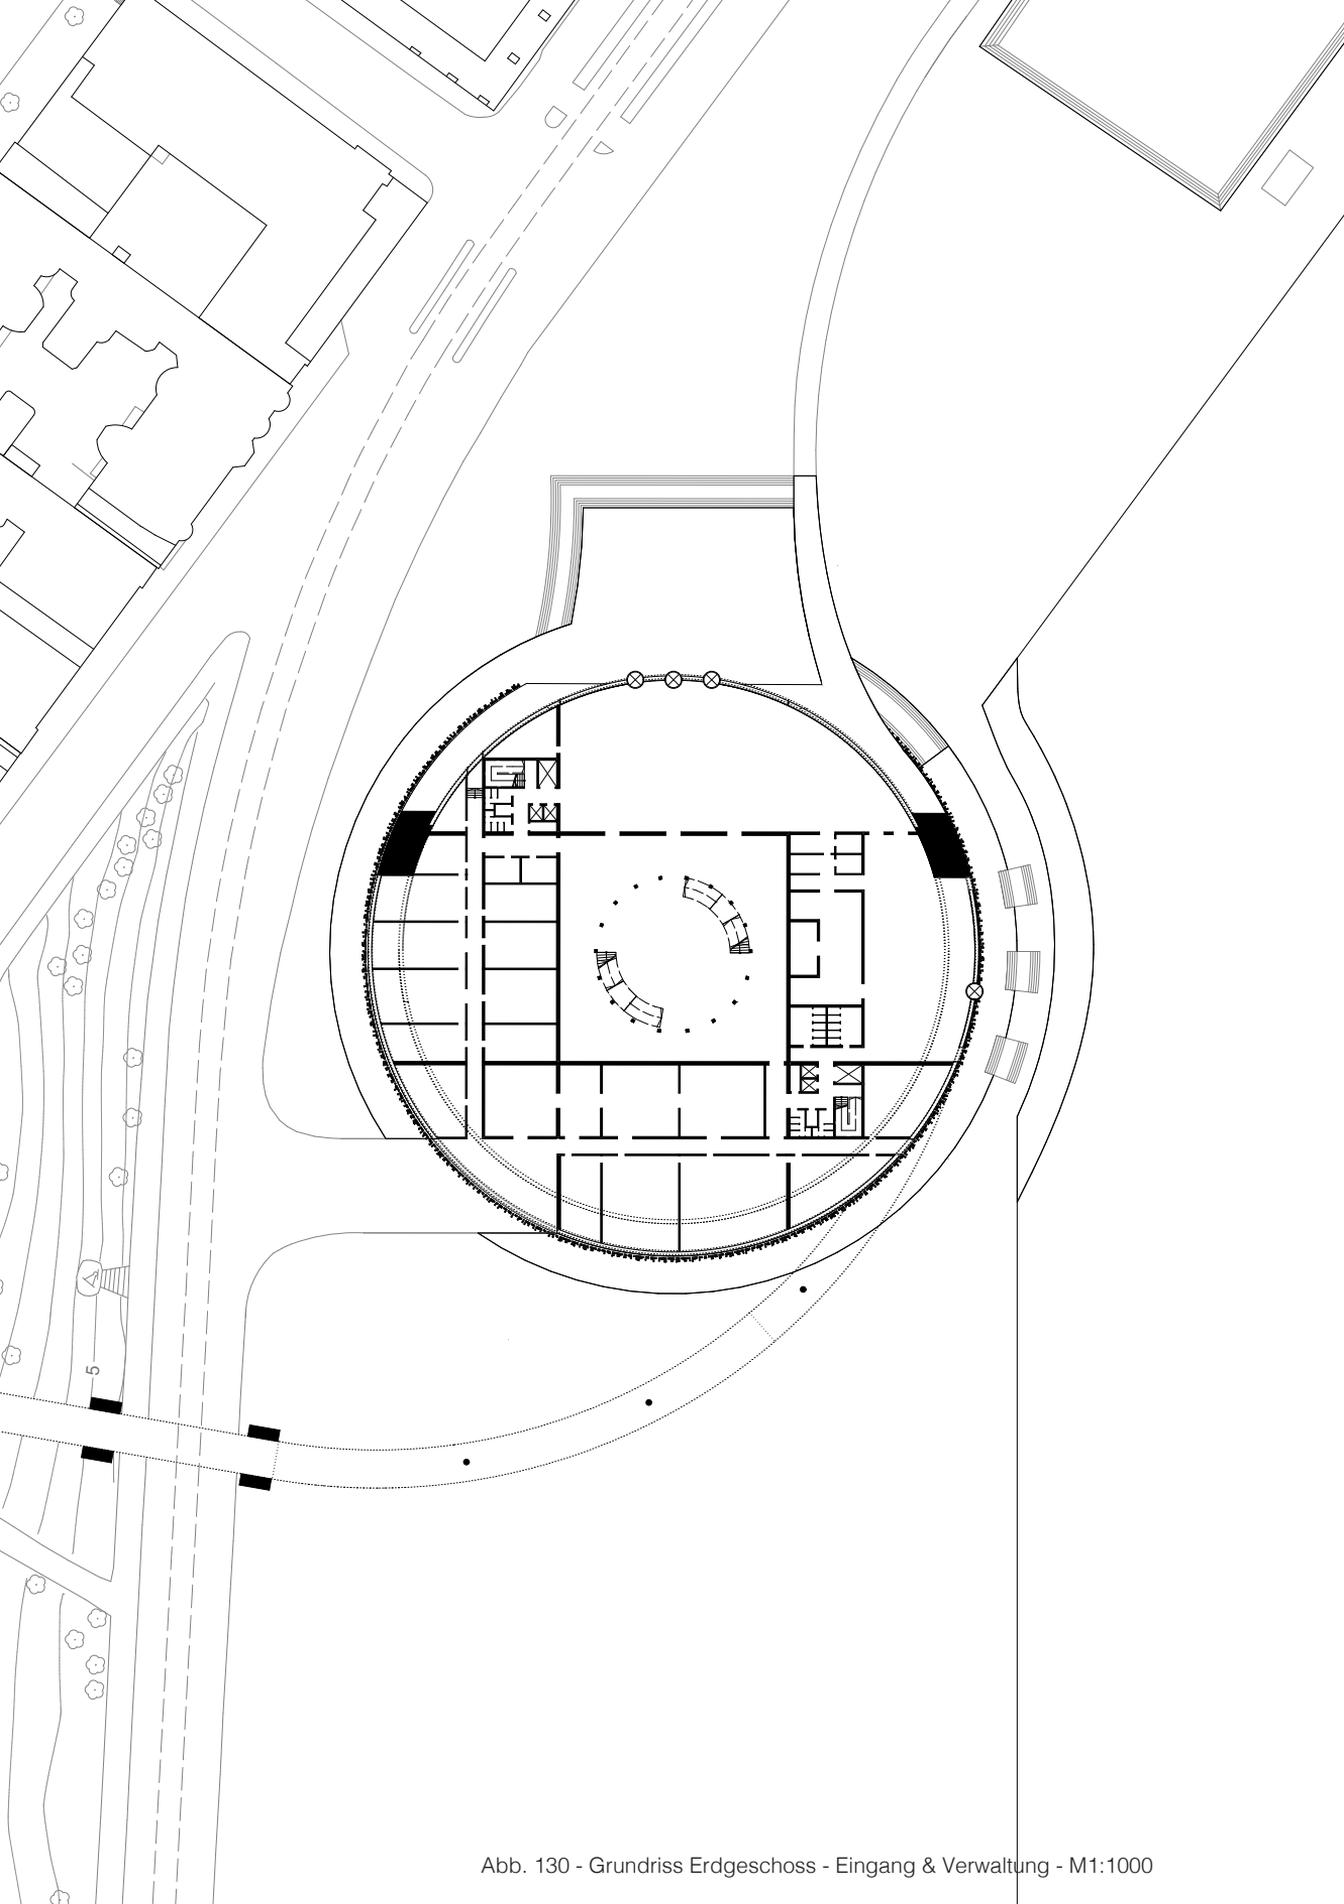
Grundriss Erdgeschoss - Eingang & Verwaltung - M1:1000
